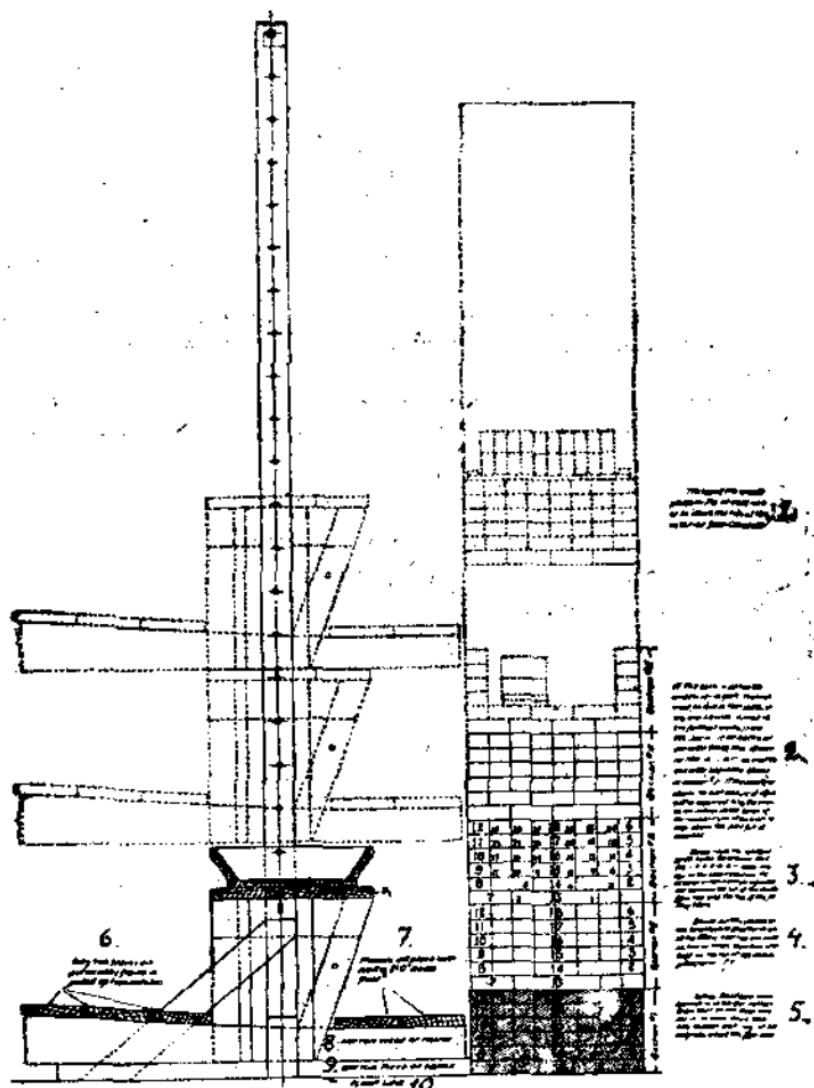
„Пакетный“ тип лесов Гильбрета, приспособленный для подачи материала на тачках.
